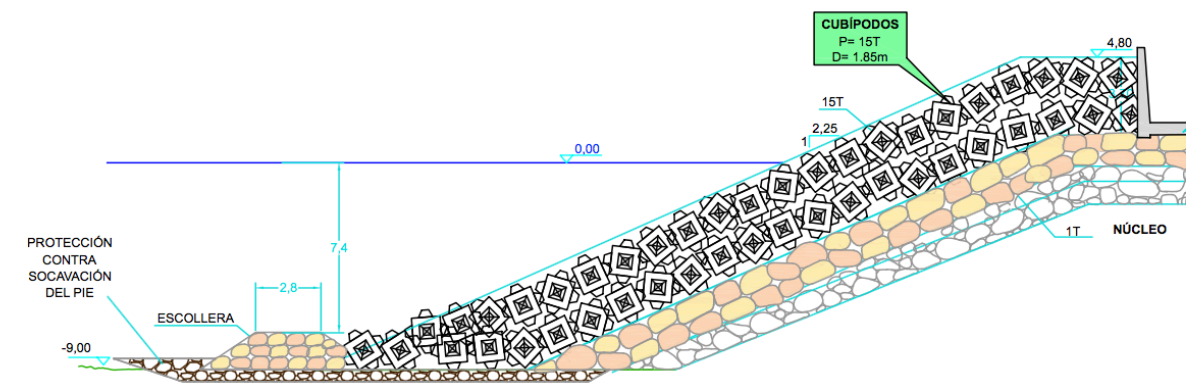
Figura VI.d.-Sección transversal de la solución adoptada en el morro. (Elaboración propia, 2018).
